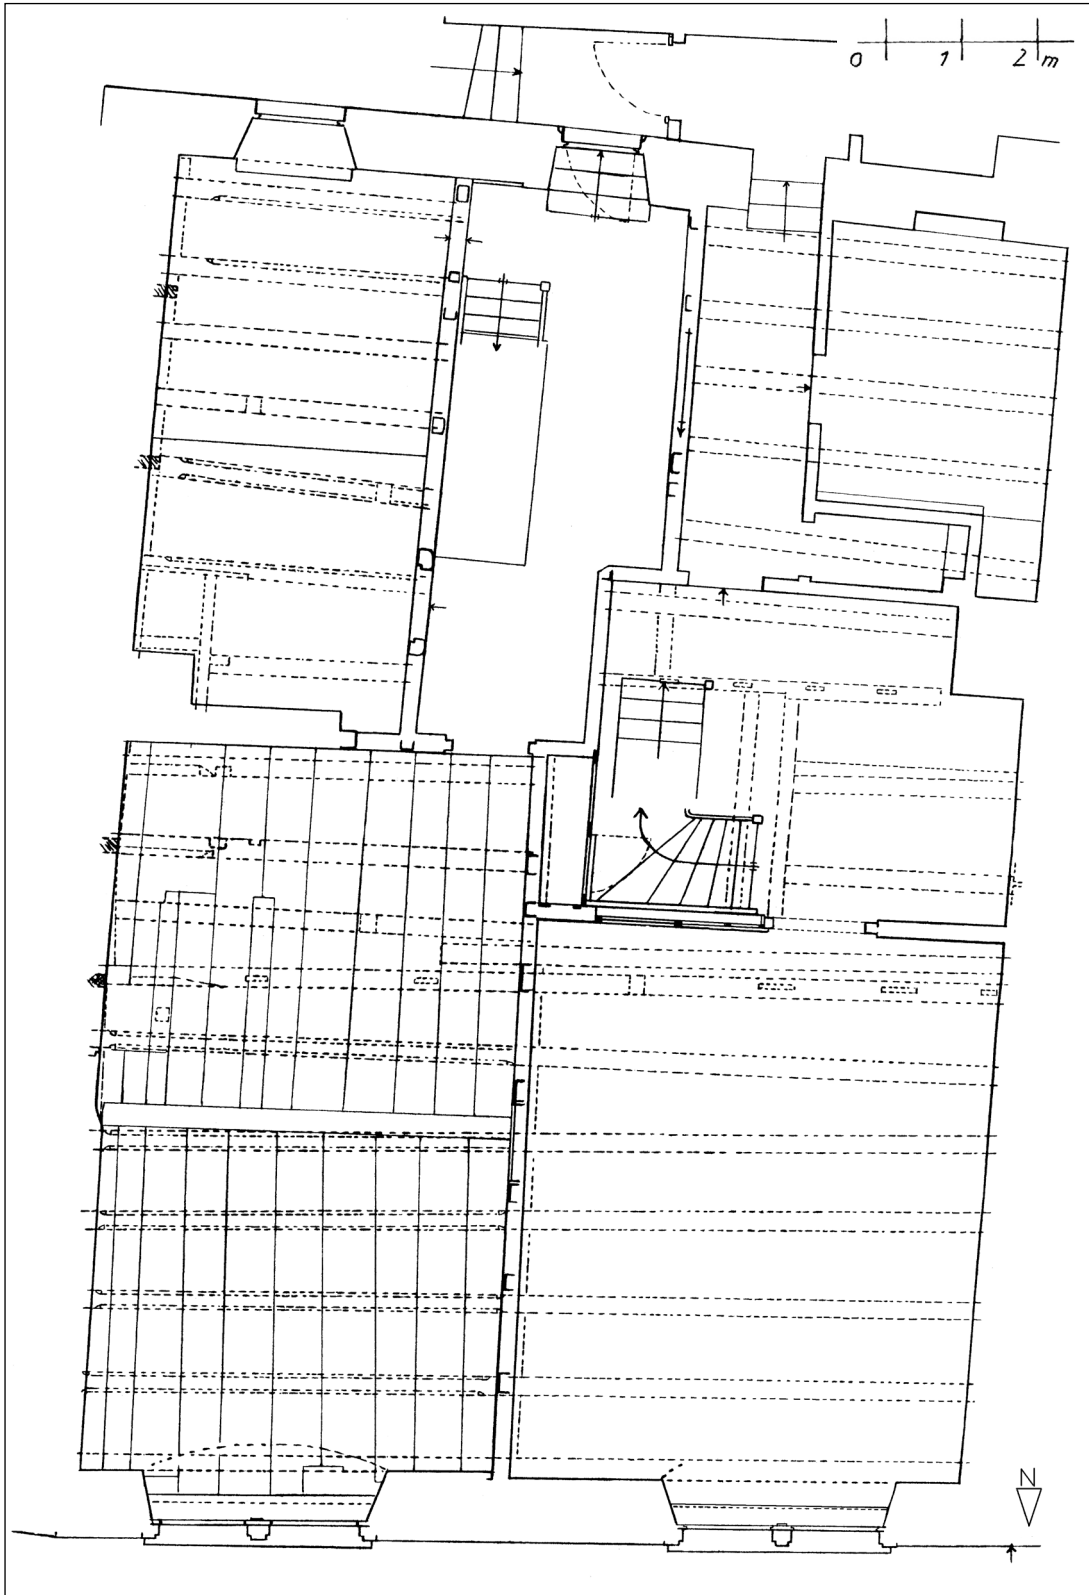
Hauptstraße 55, Grundriss 1. Obergeschoss.
